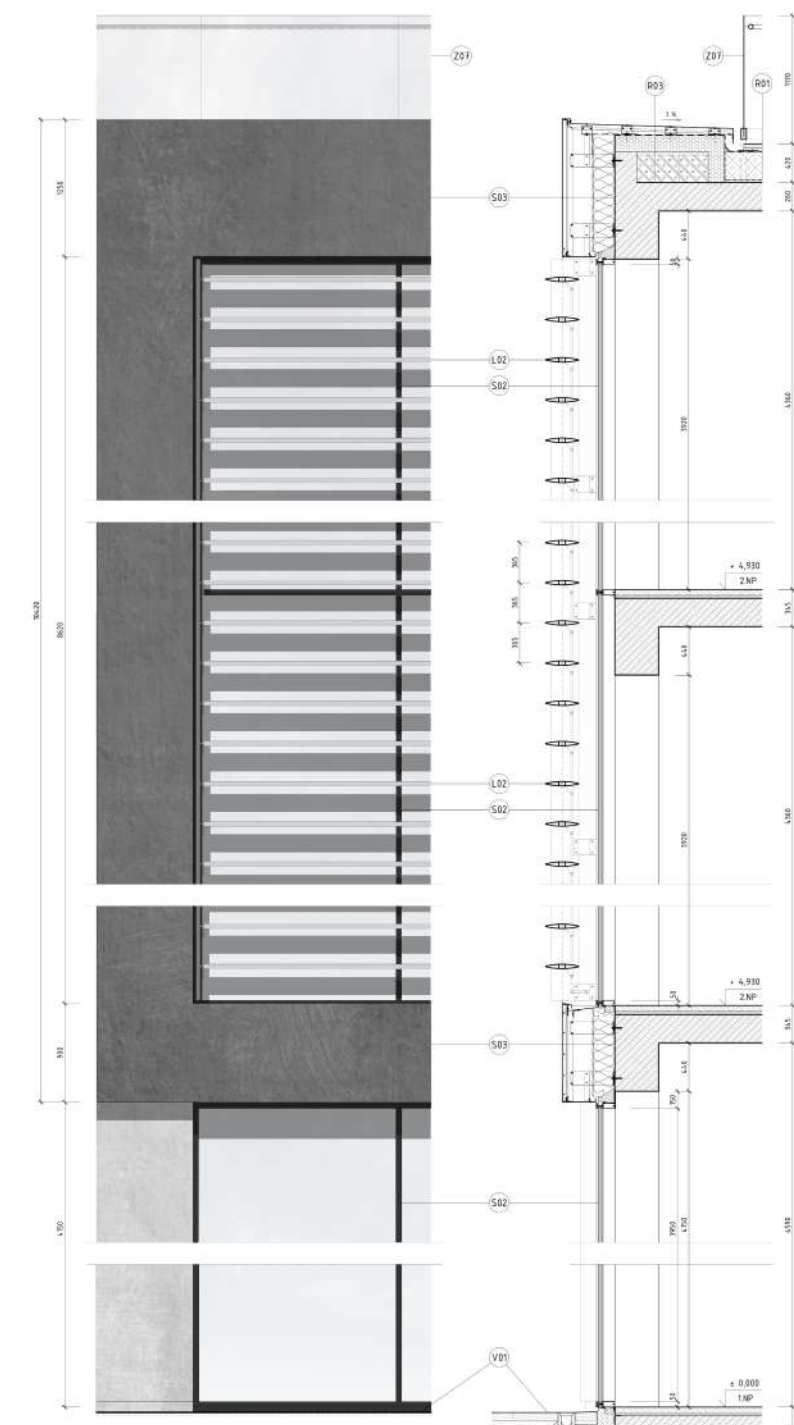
DETAIL ROZŠÍŘENÉ ATIKY S PLECHOVÝM OBKLADEM
